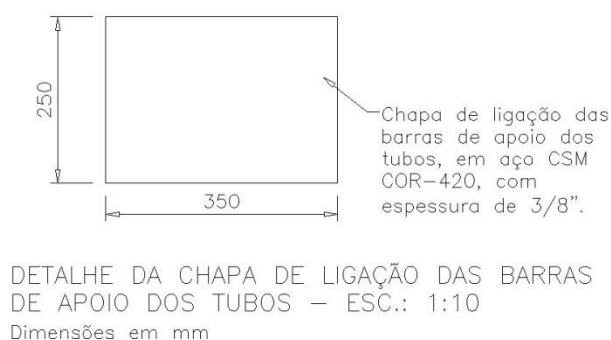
Detalhe da chapa de ligação das barras de apoio dos tubos.
